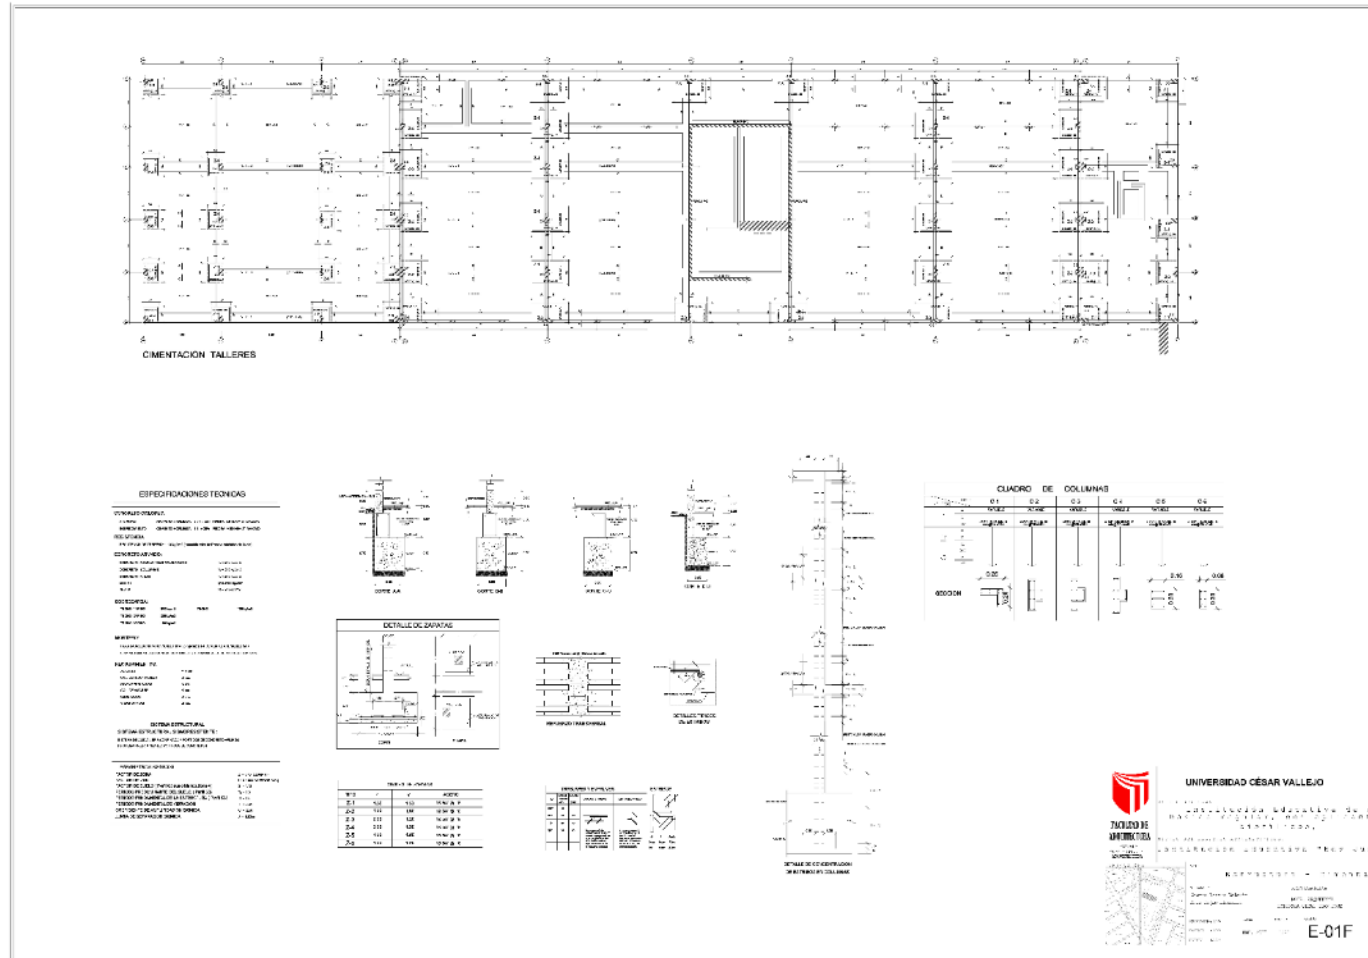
Plano de cimentación bloque "F", Fuente: elaboración propia
